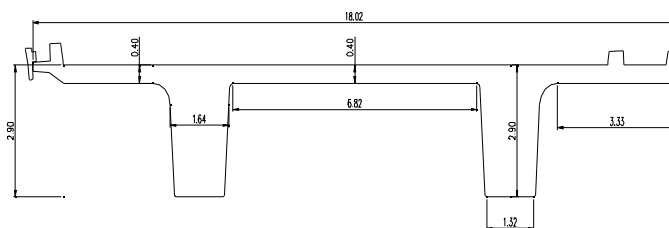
Corte transversal do tabuleiro na zona corrente do viaduto.
